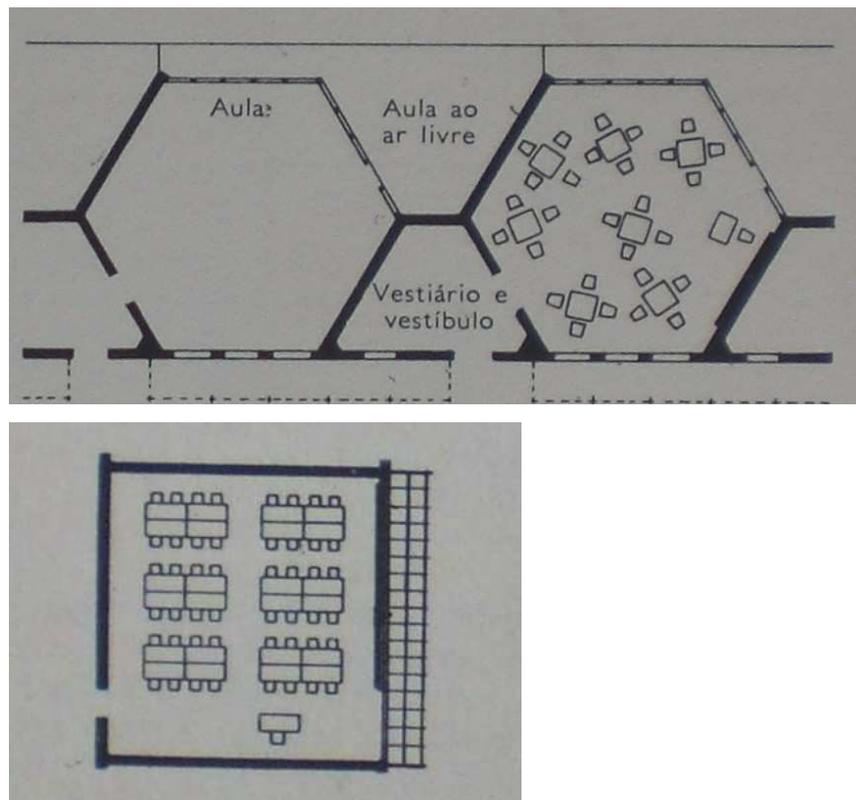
Plantas baixas de Salas de aula com a disposição em grupos.
